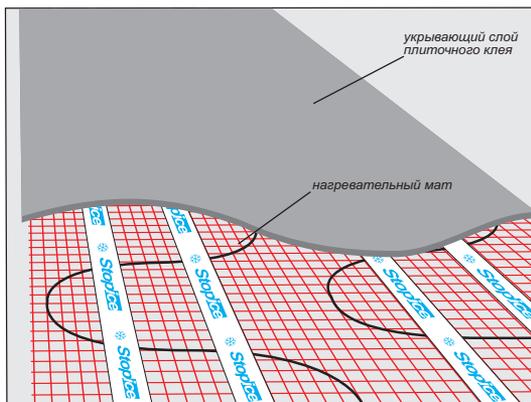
Заливка нагревательного мата раствором для крепления плитки
